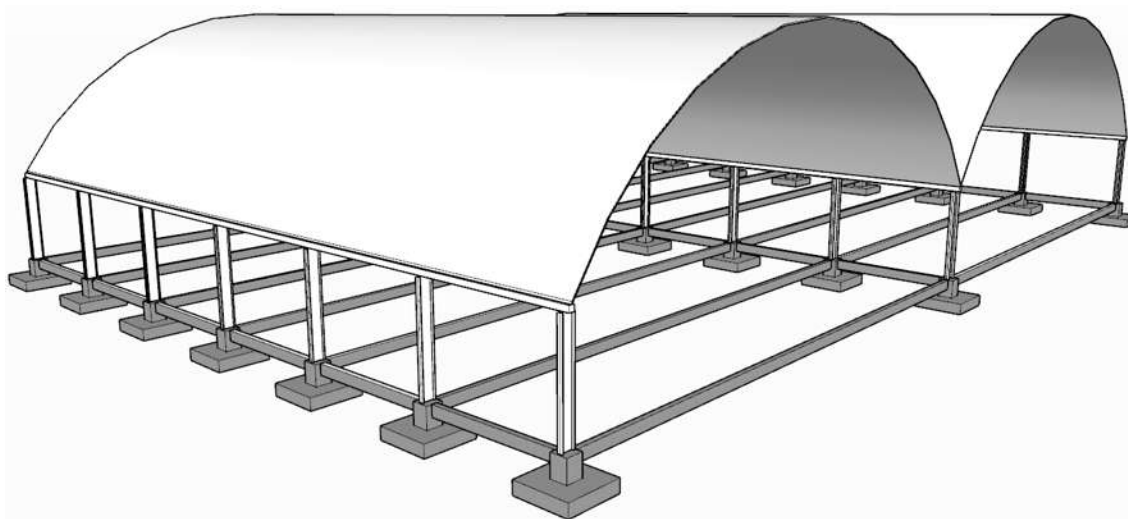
(g) Sistema estructural para la cubierta en arco circular
